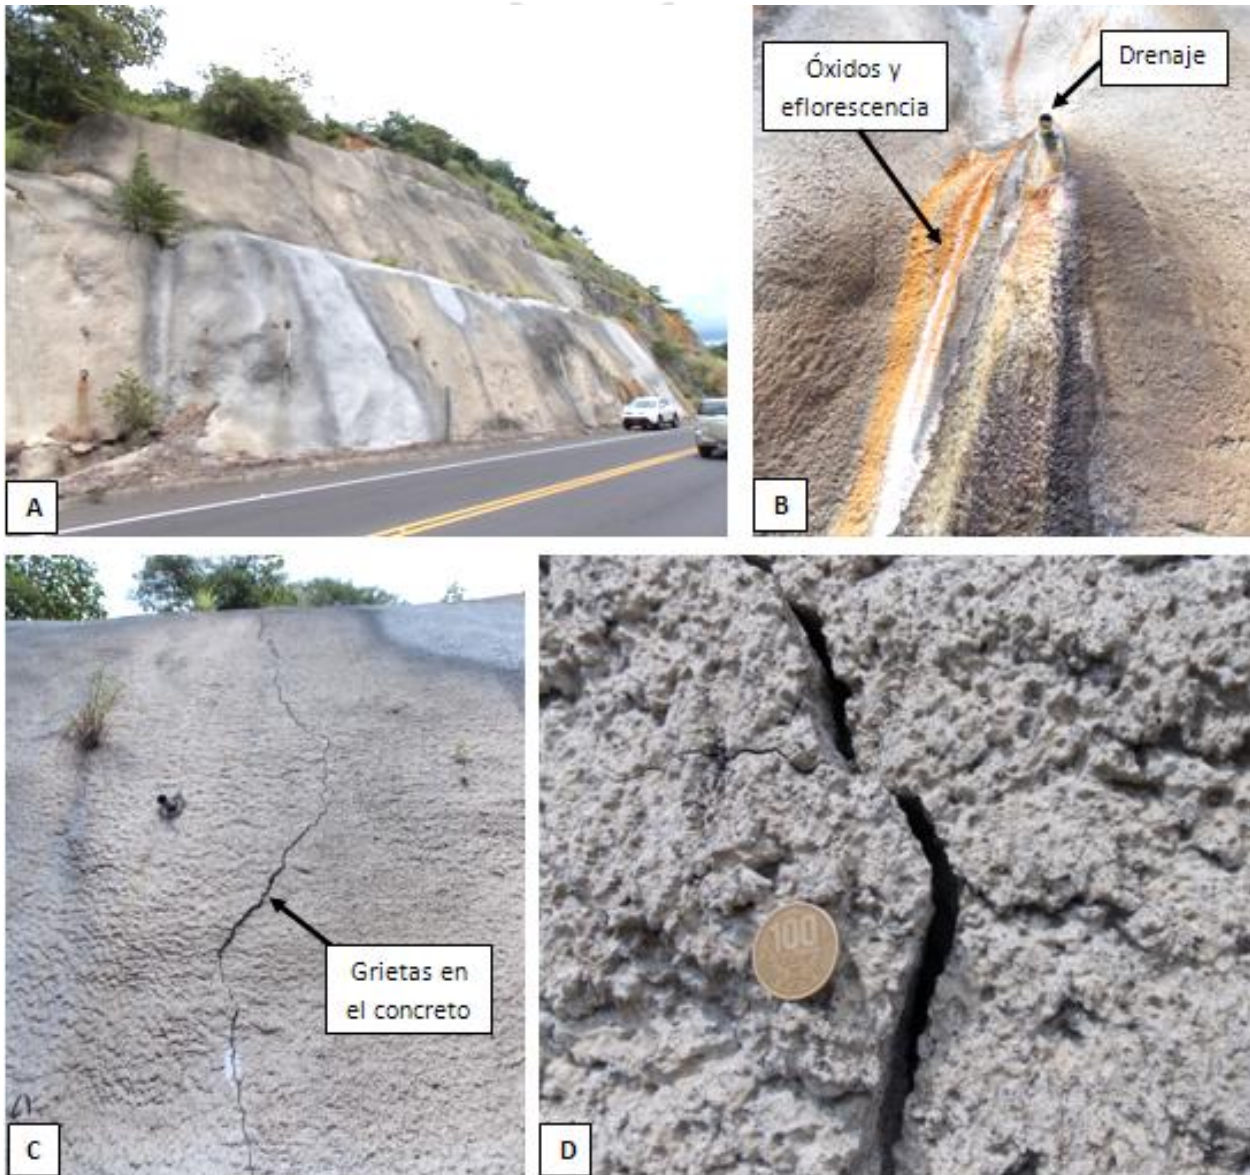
Deterioros observados en el talud del km 47+000, RN-27. A) Vista general de talud con concreto lanzado al LD. B) Salida de drenaje con presencia de óxidos y sales. C) Grietas de aproximadamente 6 m de longitud, observadas en el concreto lanzado. D) Detalle de grieta con ancho mayor a 1 cm.
